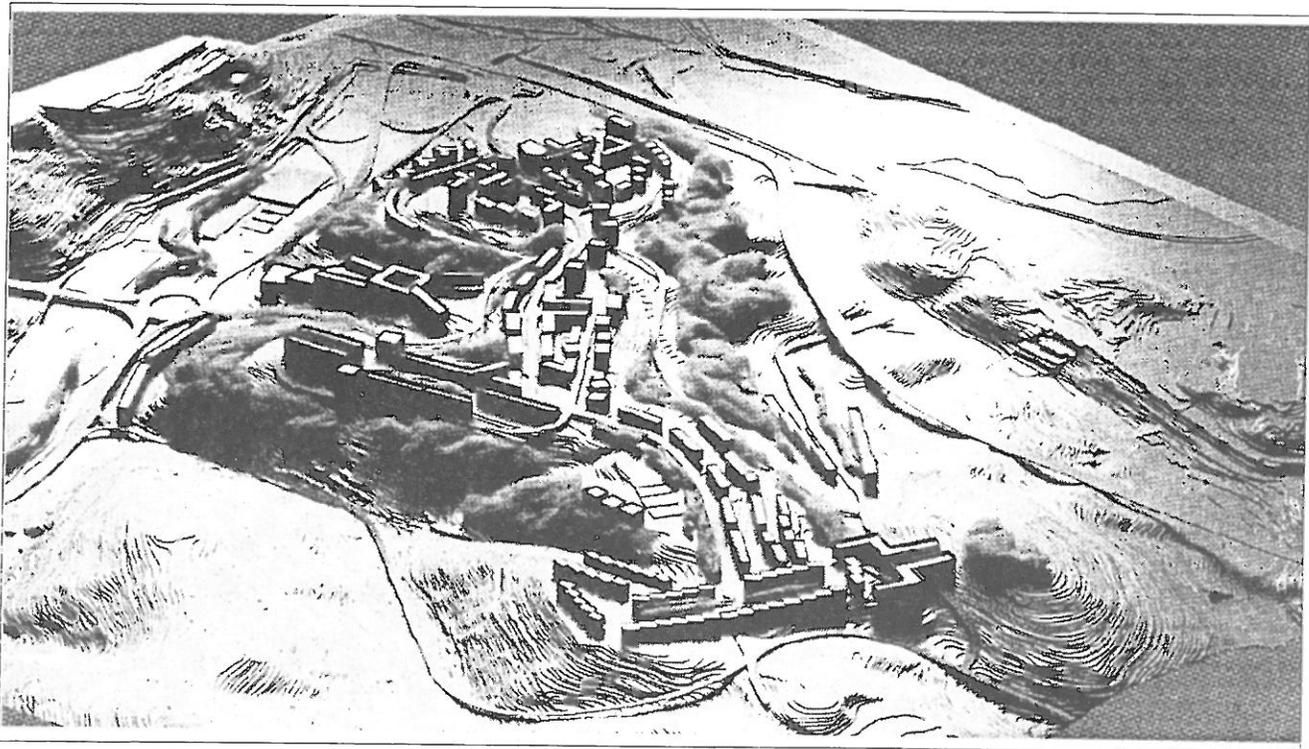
Bairro do Ingote e da Rosa - Maquete de Hestnes Ferreira
